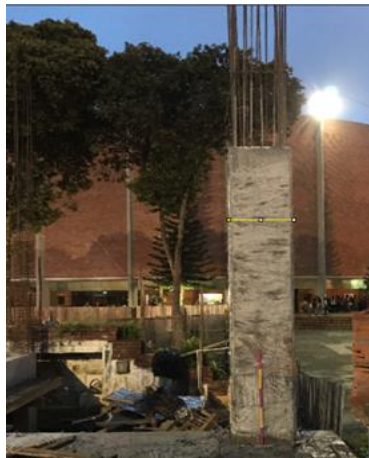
Columna P-4, nivel 2 del edificio de Ingeniería Mecánica
